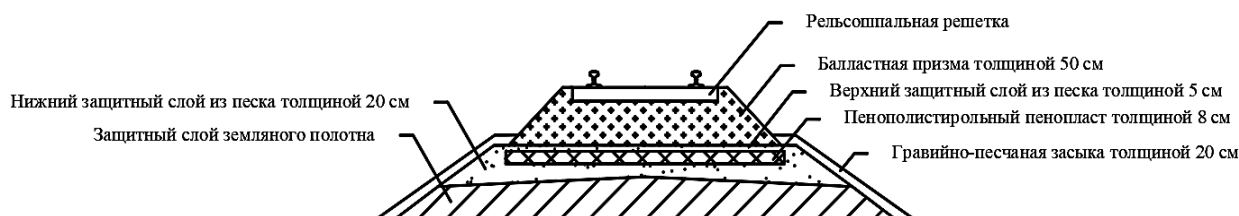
Схема размещения тепловой изоляции в поперечном сечении железной дороги
